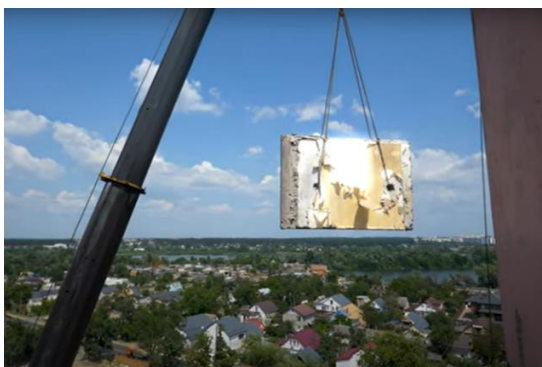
Демонтаж багатоповерхового будинку в Ірпені
